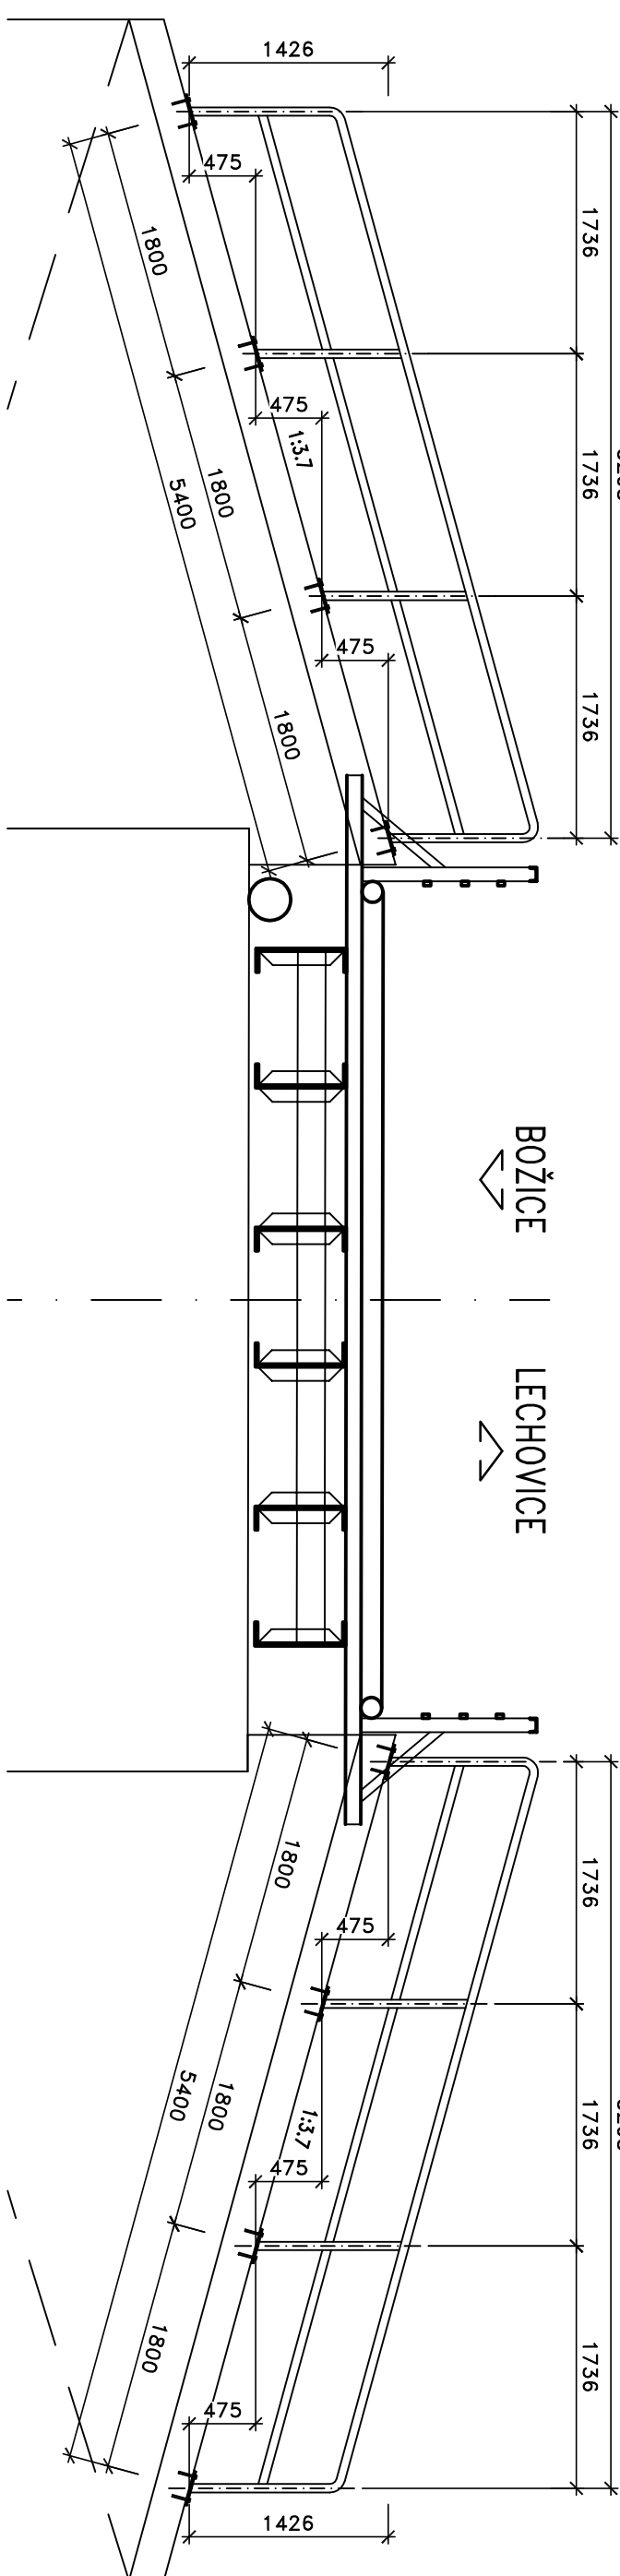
### DETAIL KOTVENÍ ZÁBRADÍ M 1:10
